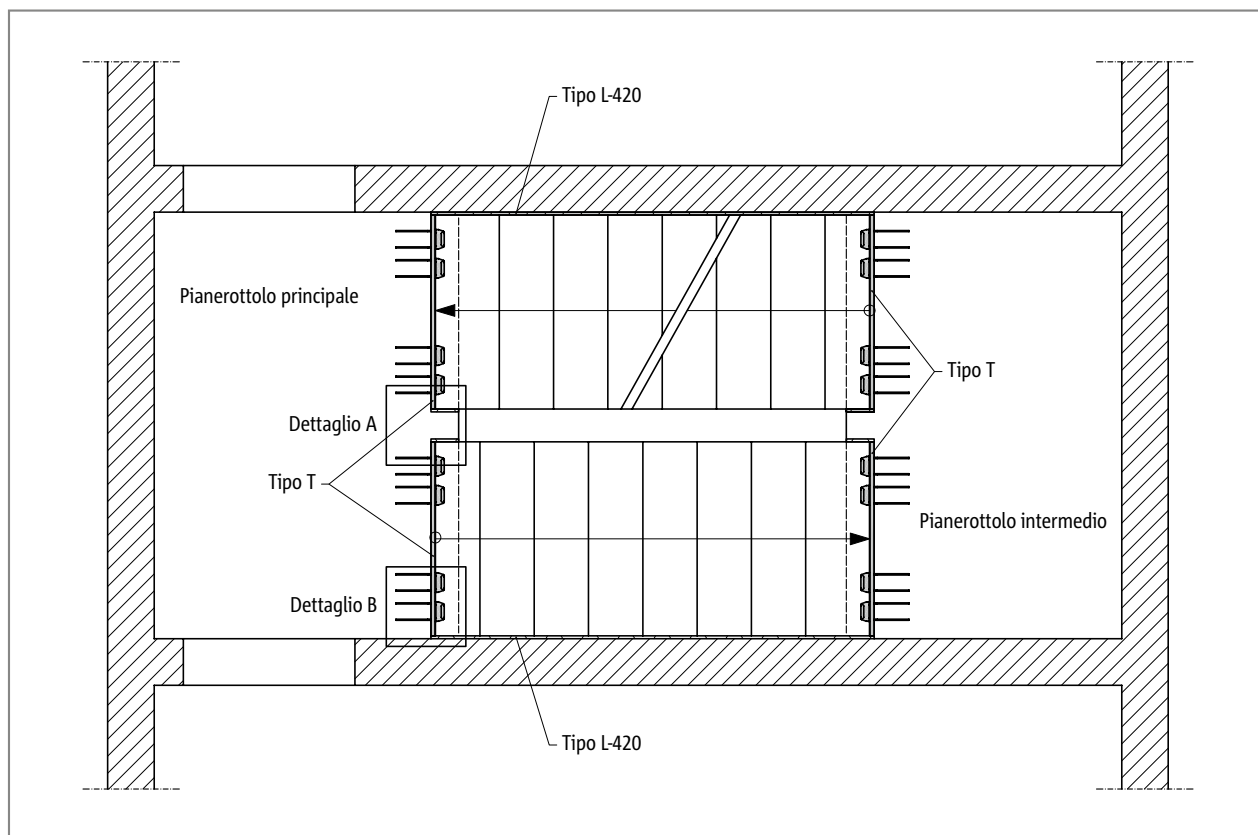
Schöck Tronsole® tipo T, disposizione dell'elemento in pianta
